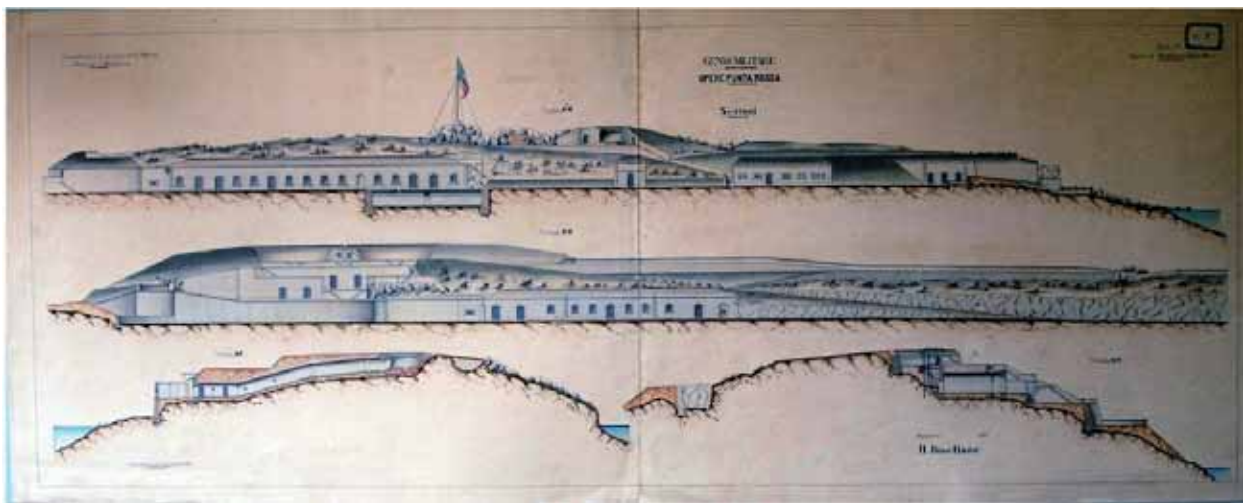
Disegni degli elevati di Punta Rossa, 1891 (arch. P. Cianchetti)
